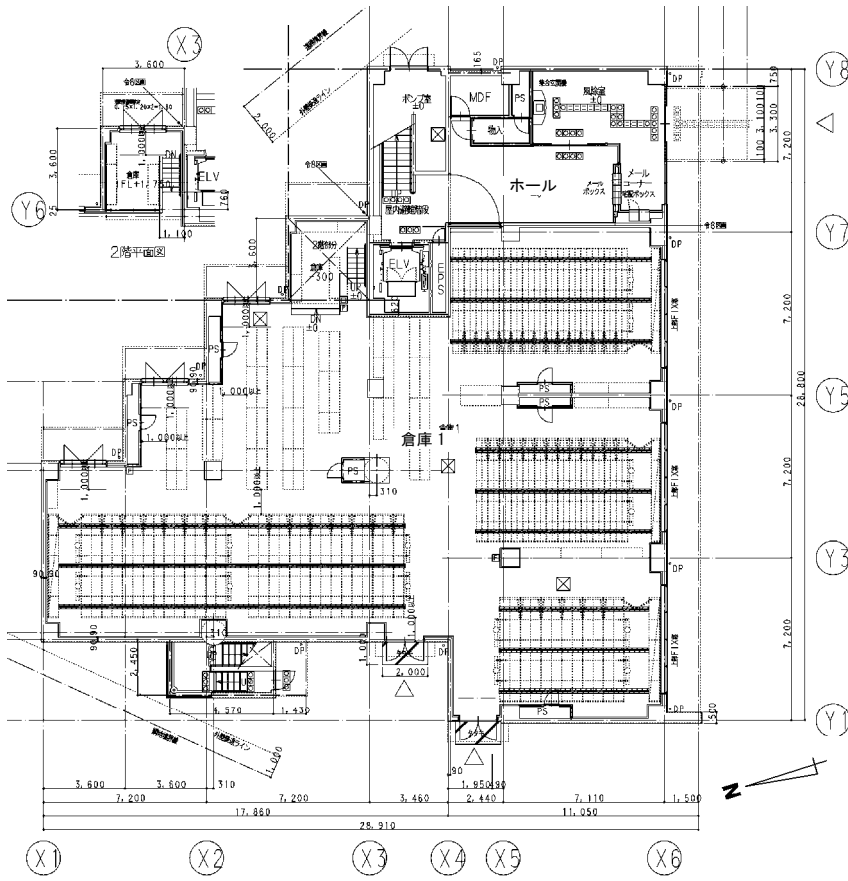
研修医宿舎棟建築平面図 (1階2階)
